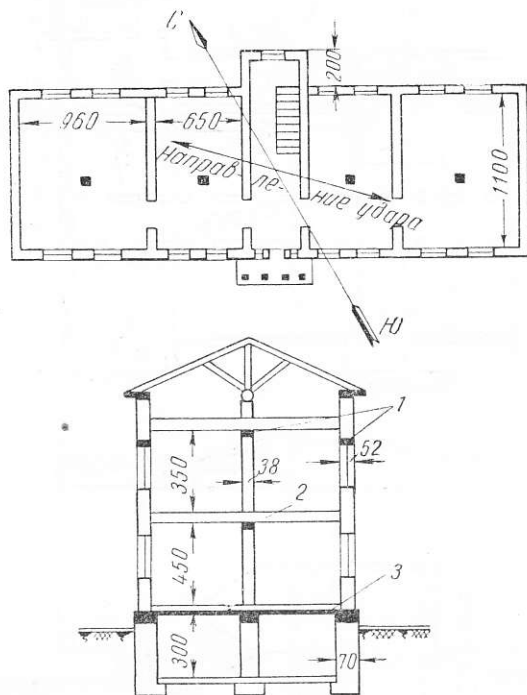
Схемы плана и разреза здания Туркменковерсоюза
